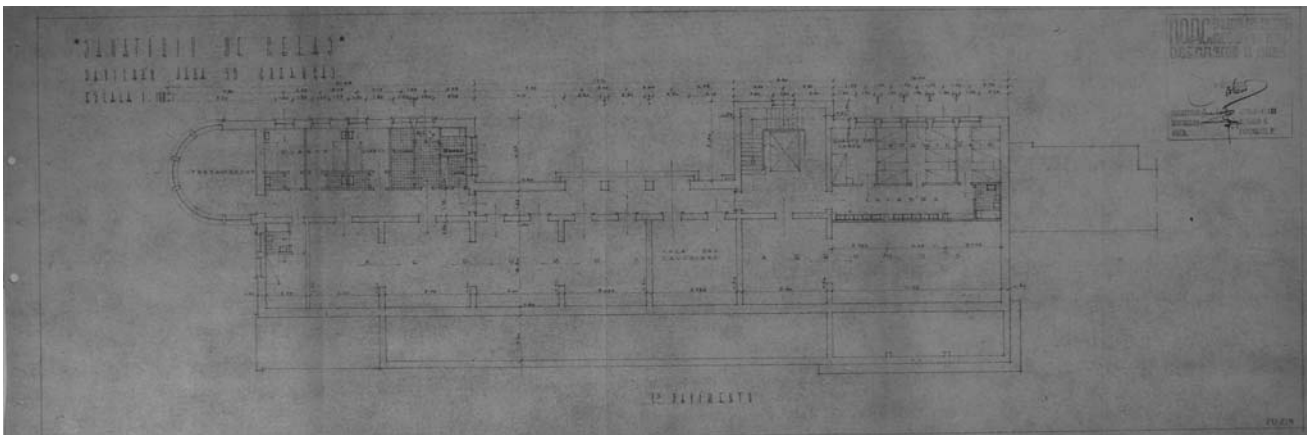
Pavilhão para 50 crianças - Planta do 1º. Pavimento. SIPA: DES\_815859.
